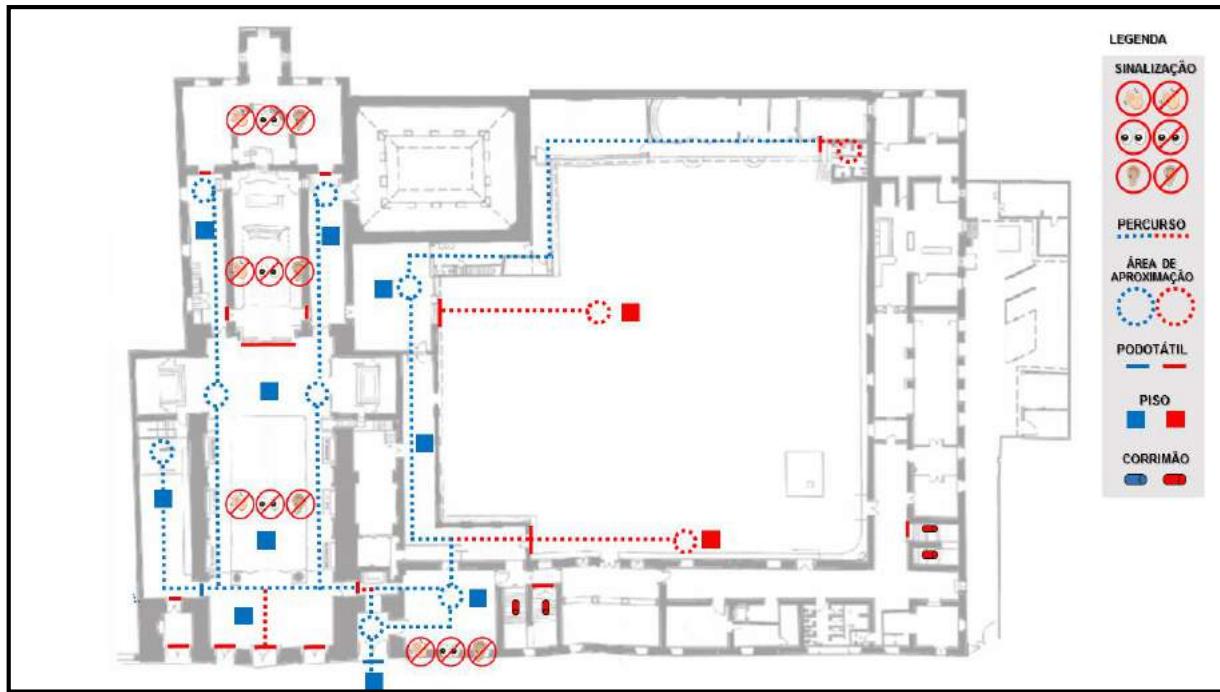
Planta Baixa - Pavimento térreo. Fonte: Inventário Nacional de Bens Móveis – INBMI - IPHAN. Disponível e capturado em junho de 2015.
